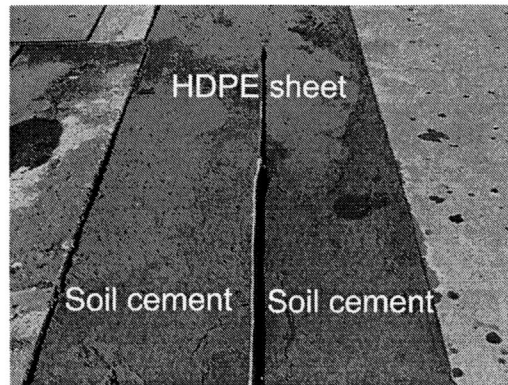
鉛直遮水壁（タイプ 2）の施工状況
